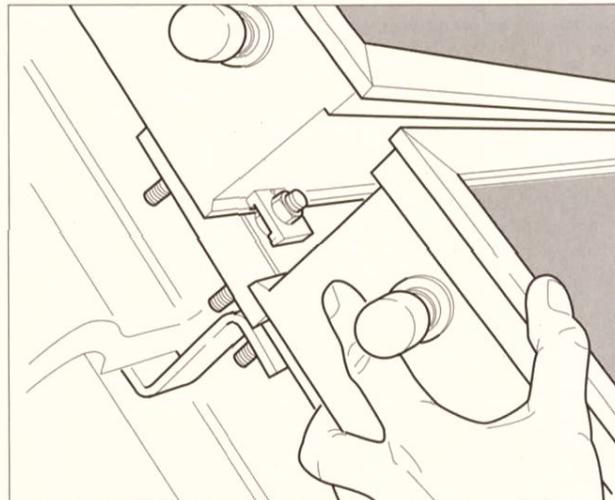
Unteren Kollektor mit der Oberkante unter Befestigungsklemme schieben und die unteren Befestigungsklemmen so festschrauben, dass Pfeil zum Kollektor zeigt.
